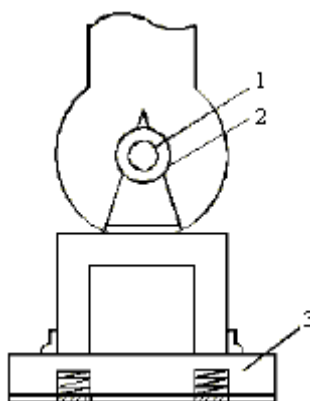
Схема вентиляционной установки: 1 – электродвигатель; 2 – воздуховод; 3 – основание установки
